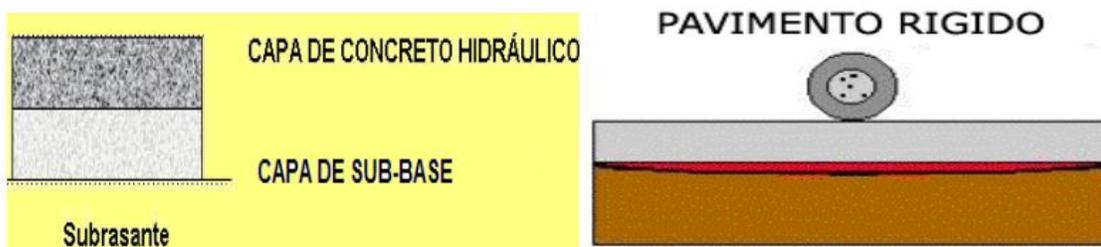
Esquema de un pavimento rígido (Ing. Claudio Giordani, Ing. Diego Leone, pavimento)
